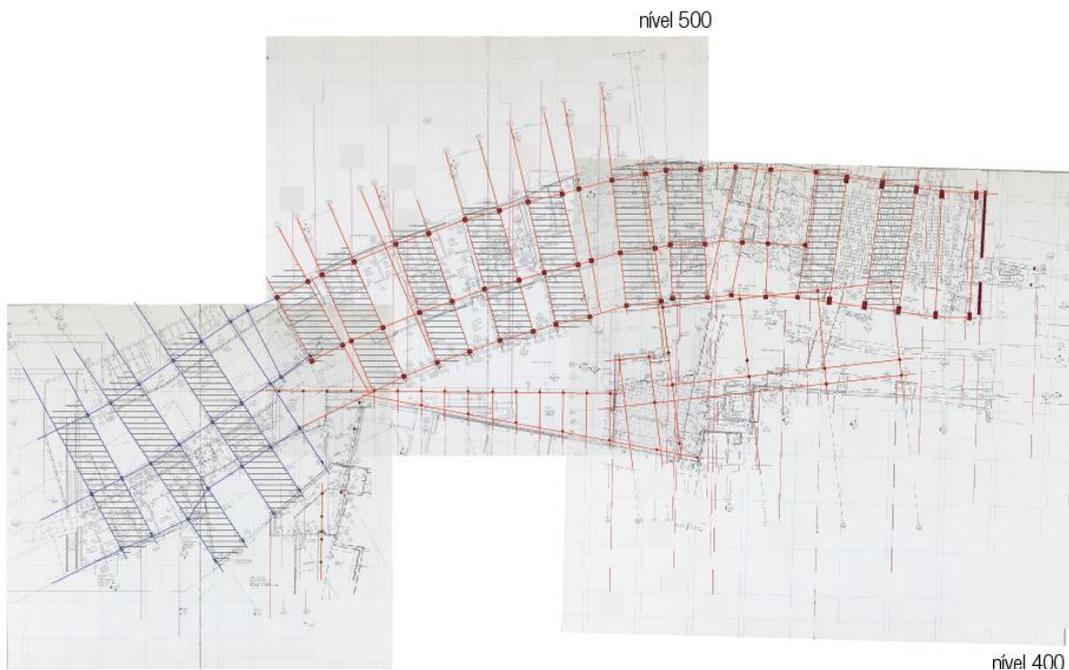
identificação dos pilares e eixos estruturais nas plantas construtivas (grafismo feito sobre plantas publicadas em Davidson (1996, p.80-81, p.86-87, p.92-93)
